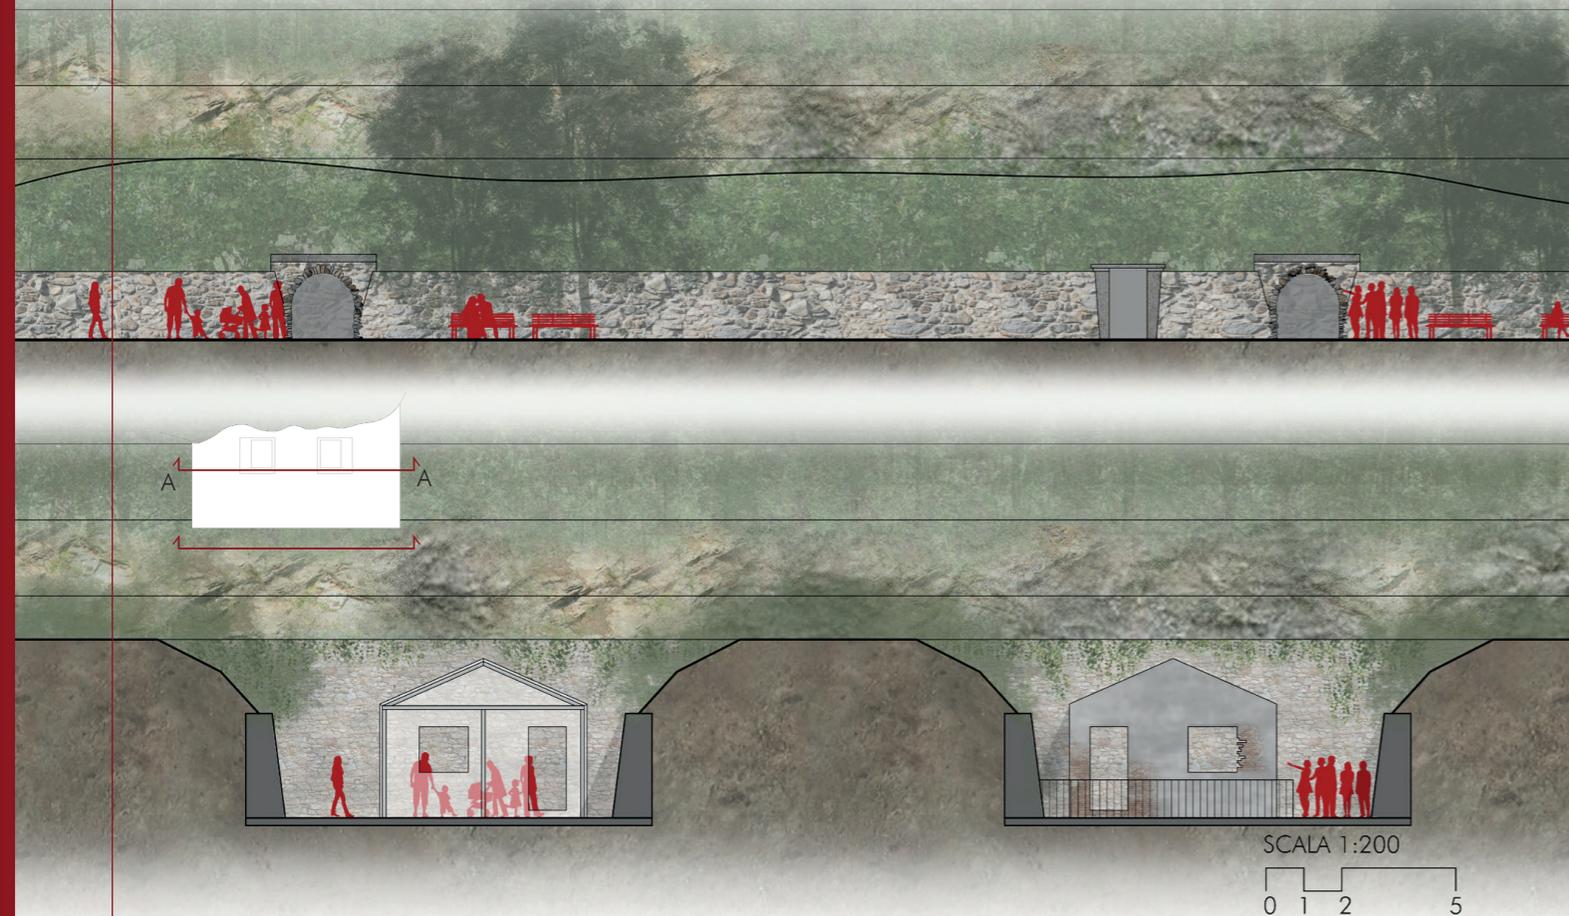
Prospetto sud-ovest e sezione AA delle "casematte", elaborazione delle autrici
